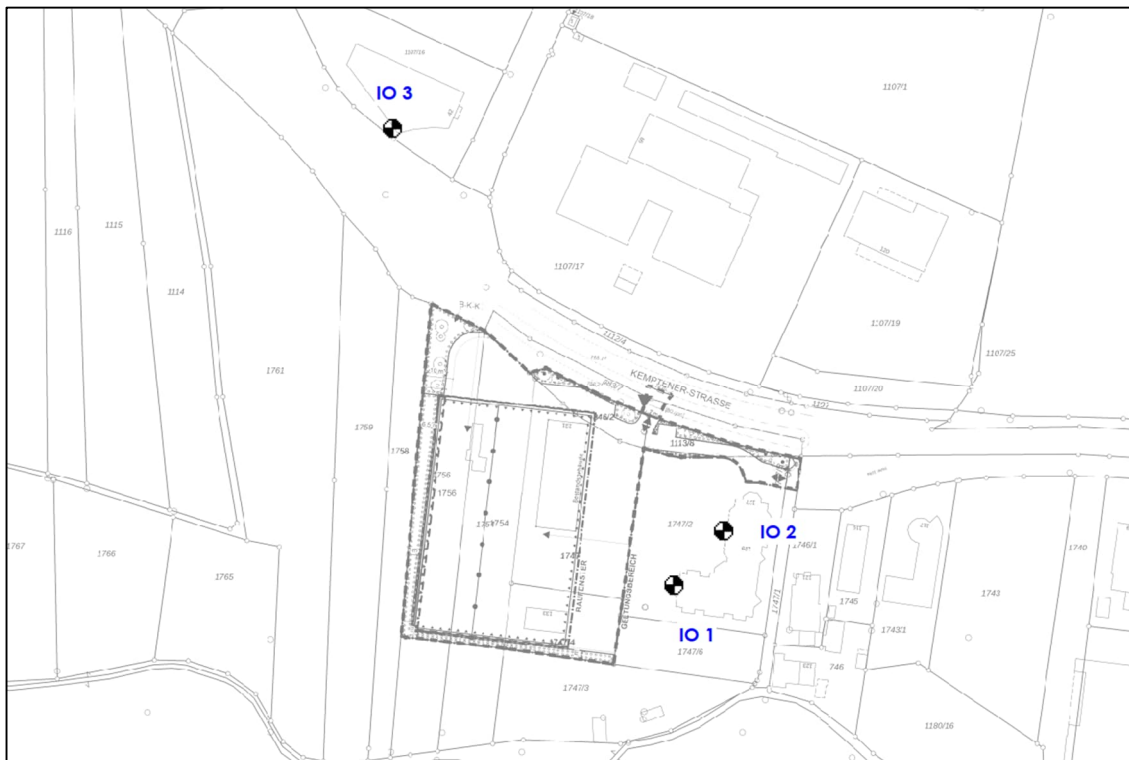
Lageplan /7, 8, 9/ mit Darstellung der maßgeblichen Immissionsorte IO
